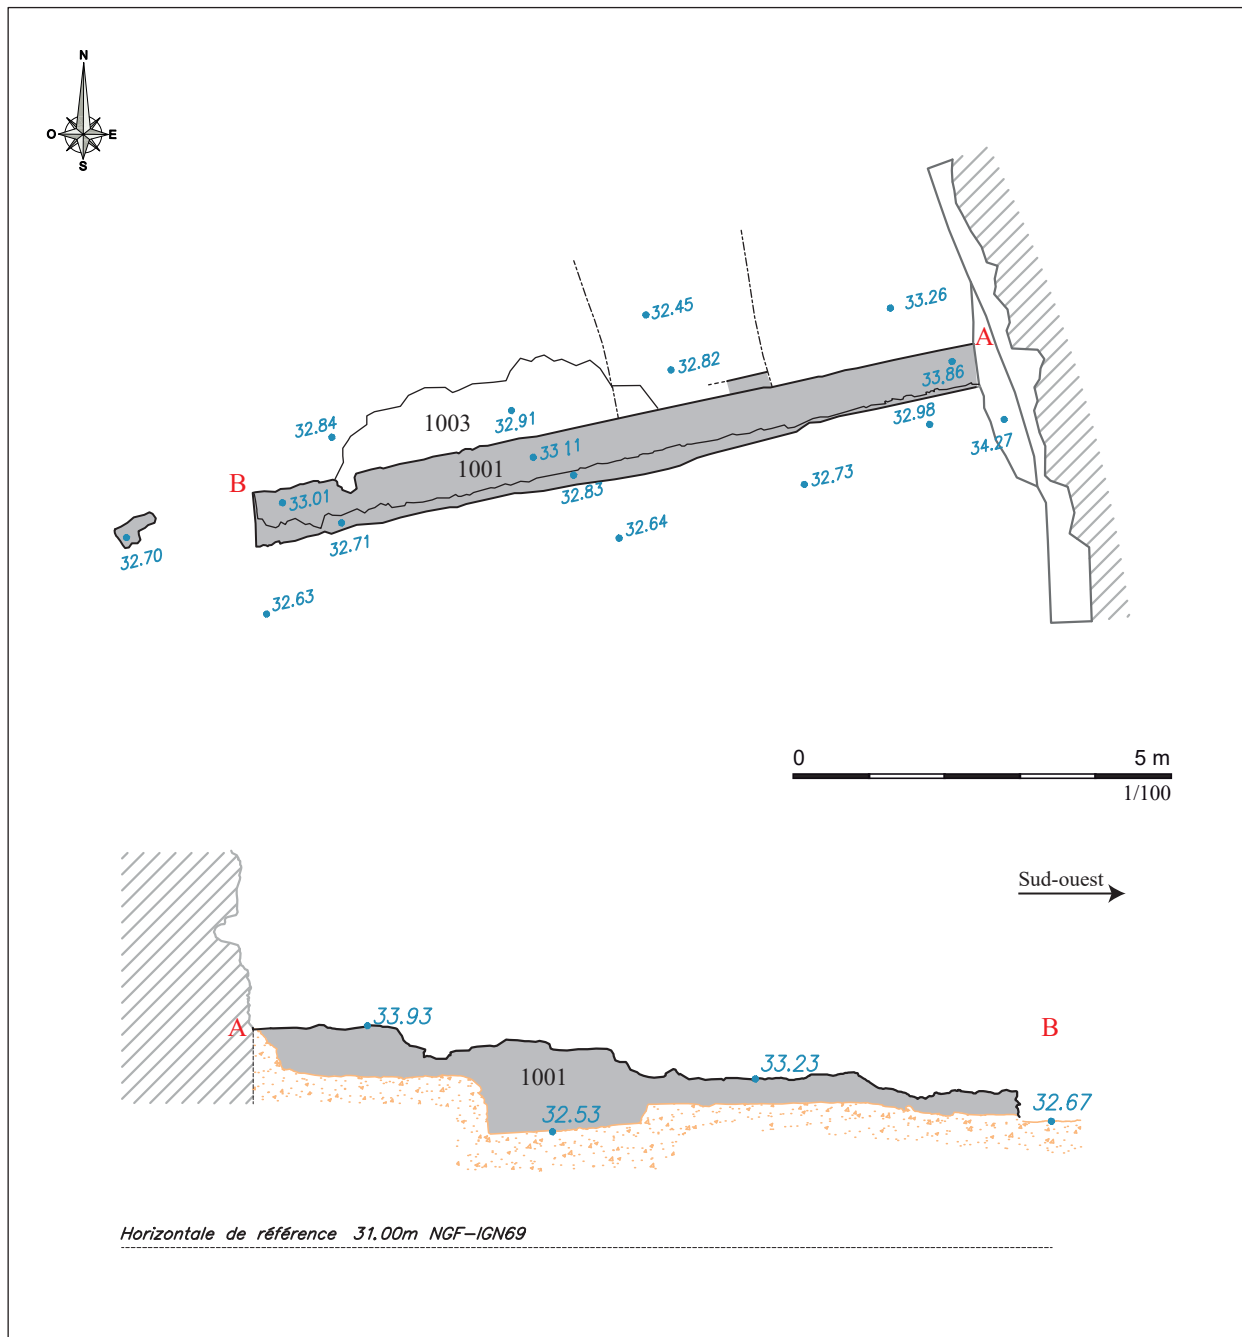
Paris (13^e arr.) - Bassin de stockage Austerlitz : plan et élévation du mur 1001.
